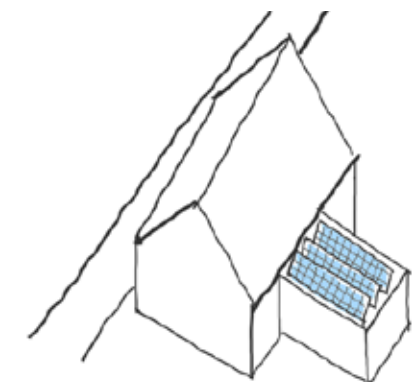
Auf straßenabgewandtem Flachdach aufgeständerte PV-Anlage
